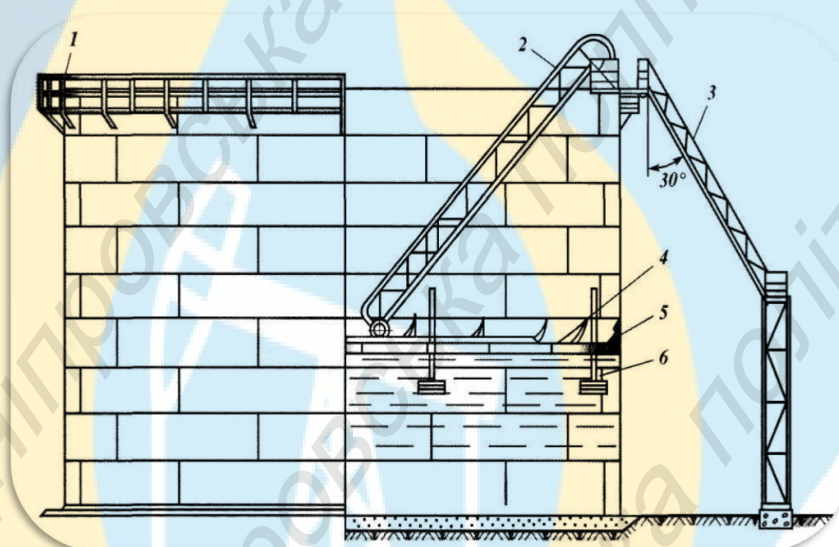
Резервуар з дводечним плаваючим дахом: 1 – перила; 2, 3 - рухомі і нерухомі сходи; 4 – плаваючий дах; 5 – затвор; 6 – опорна стійка
